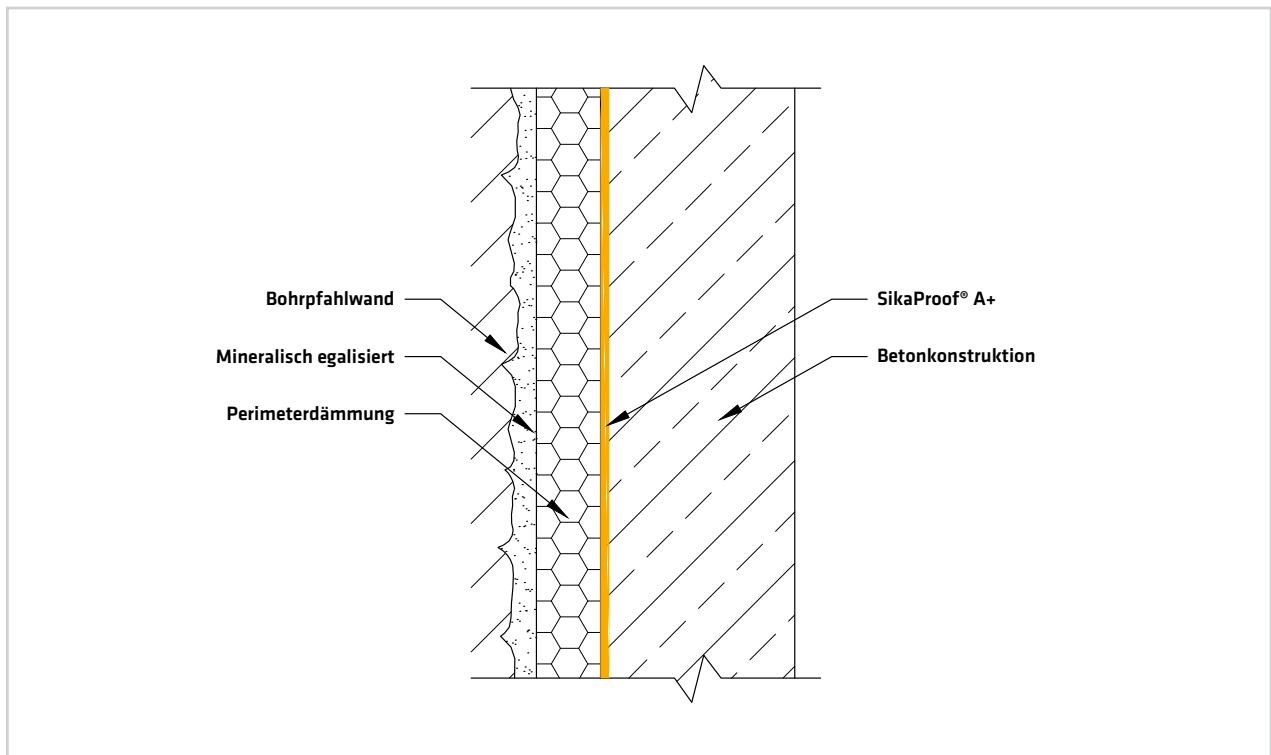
Einhäuptig geschalte Wand mit Schutzlage
